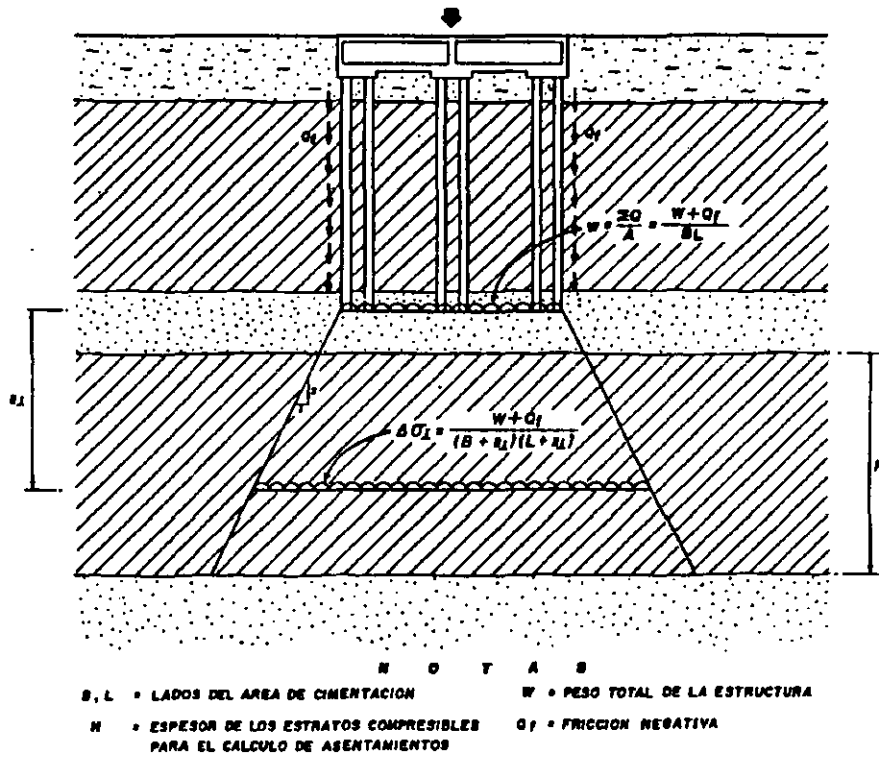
Criterio simplificado para el cálculo de distribución de esfuerzos en una cimentación apoyada en pilas o pilotes de punta
